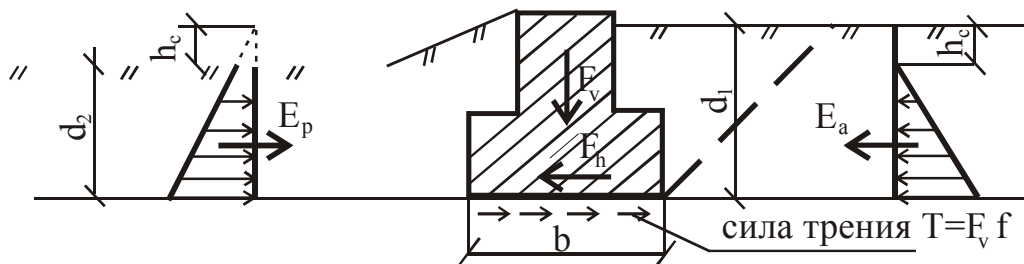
Схема к расчету фундамента на сдвиг по подошве фундамента в общем виде: f – коэффициент трения. $E_a; E_p$ – активное и пассивное давление на грунт основания
